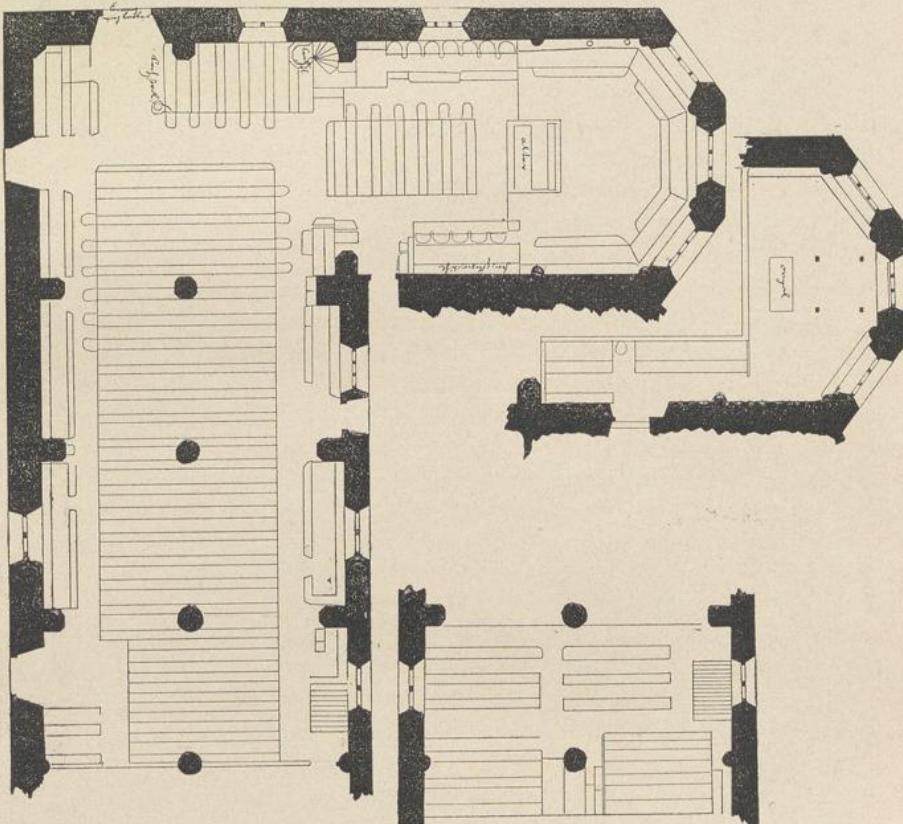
Heiliggeist-Kirche: Grundriss.
